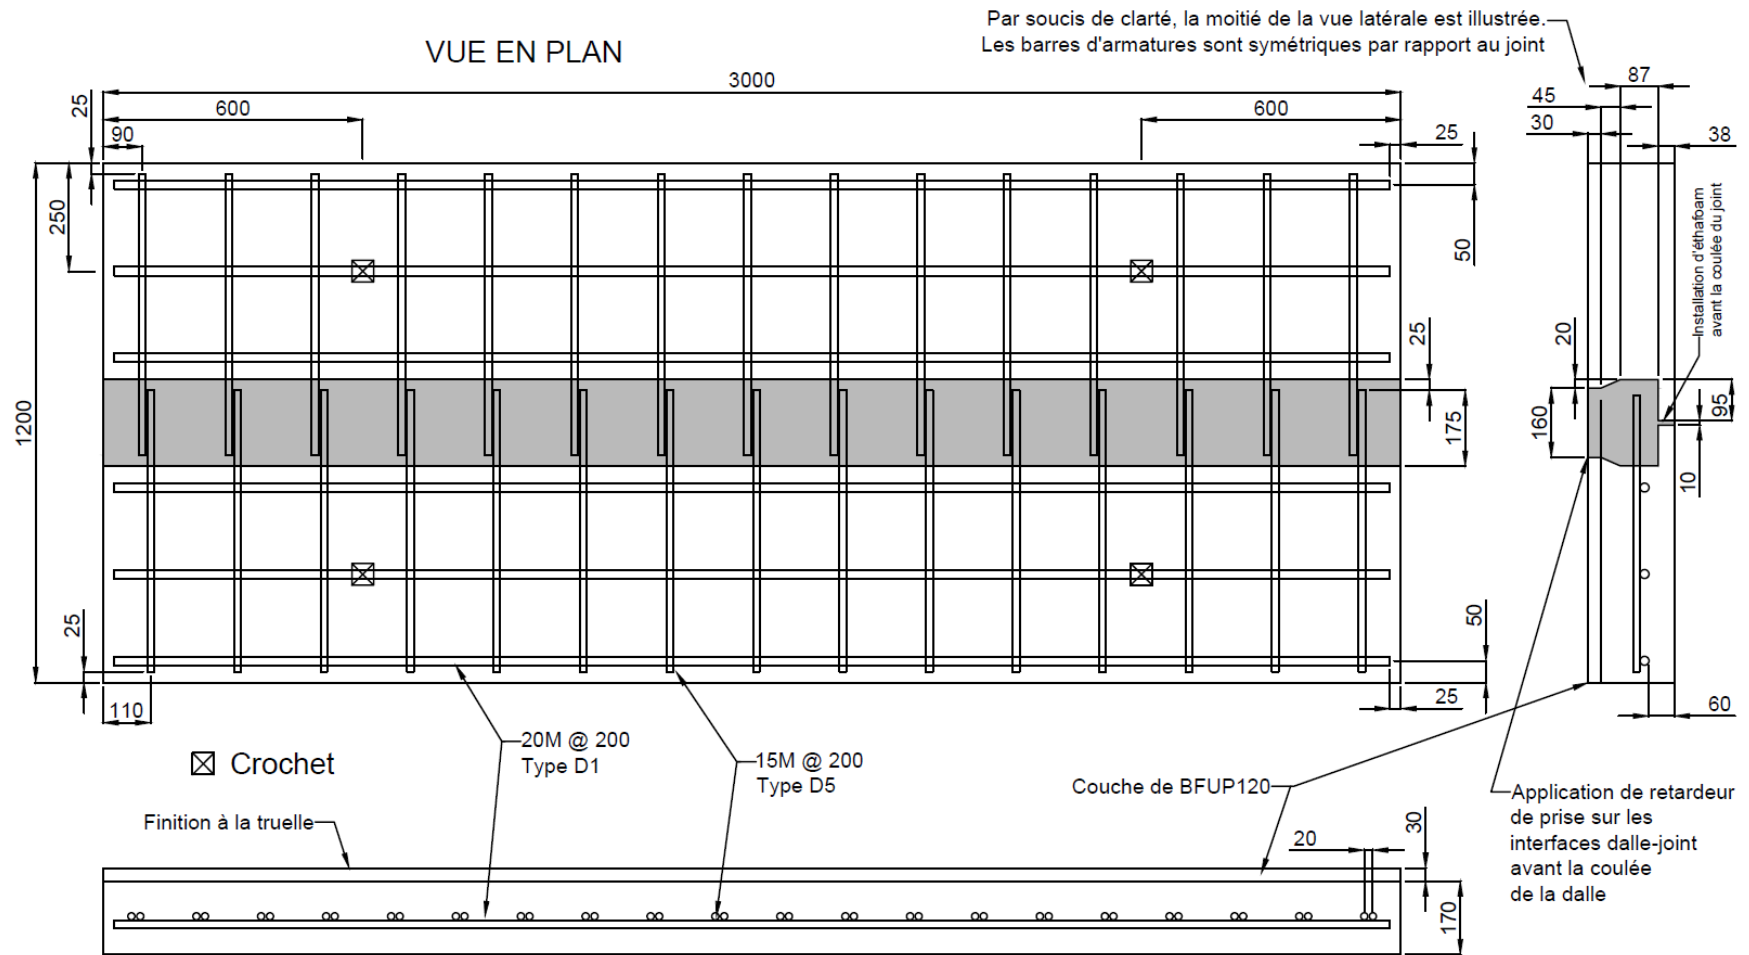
Dalle hybride avec joint de connexion transversale (Théorique)
